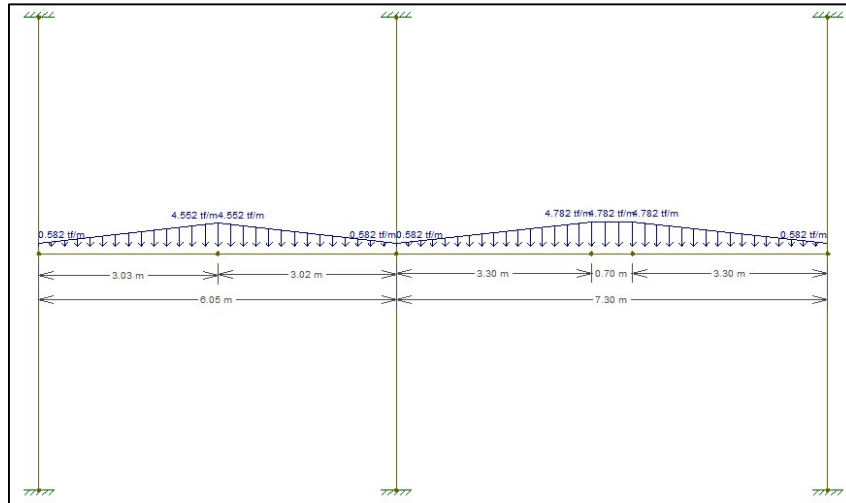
Modelo de viga VT-06 con cargas de gravedad
